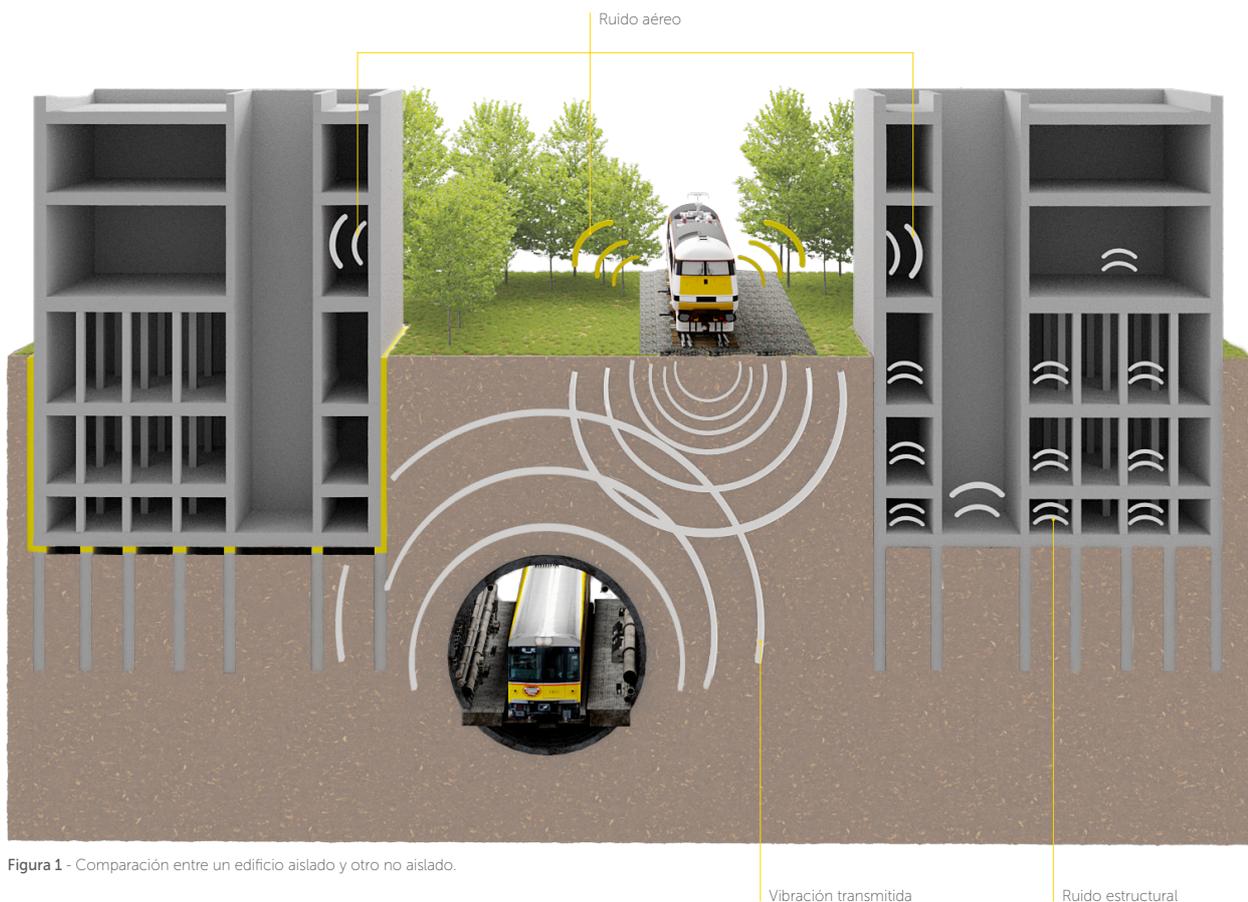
Comparación entre un edificio aislado y otro no aislado.
